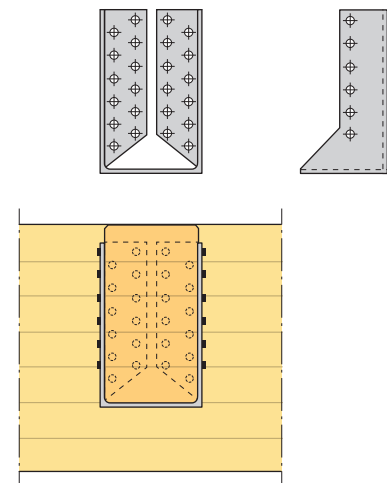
visar skillnaden mellan minimal och maximal spik- eller skruvning för ett av de vanligaste vinkelbeslagen med en bredd 105 mm. Mått och bärförmåga varierar mellan olika beslagstillverkare.
